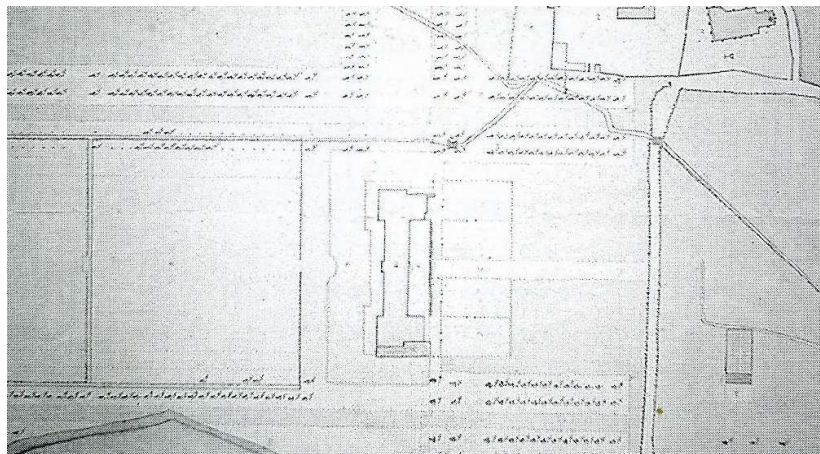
Château d'Annebault. Plan du château, s.d. (1778) (AN, Cartes et plans, N III, Eure 56 (1), publiés par BEAUMONT et SEYDOUX 1999, p. 216).
